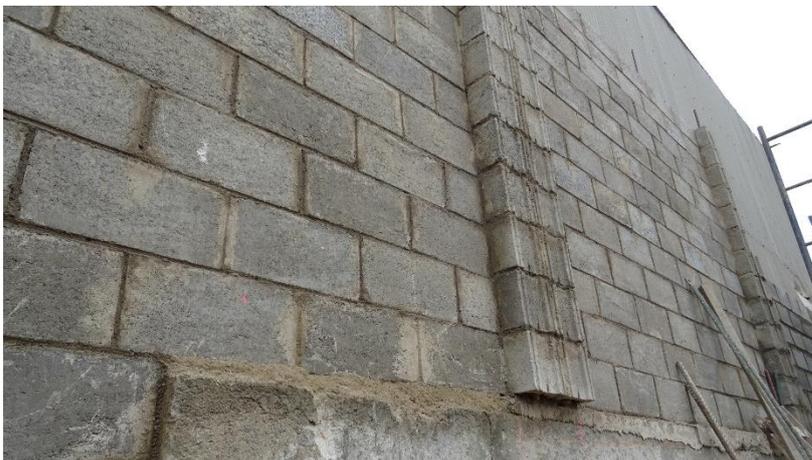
Muro no portante hecho con bloques de concreto reciclado
